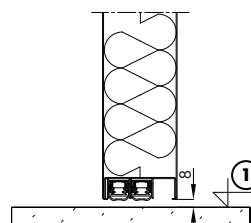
Obložková zárubeň s přerušeným tepelným mostem
